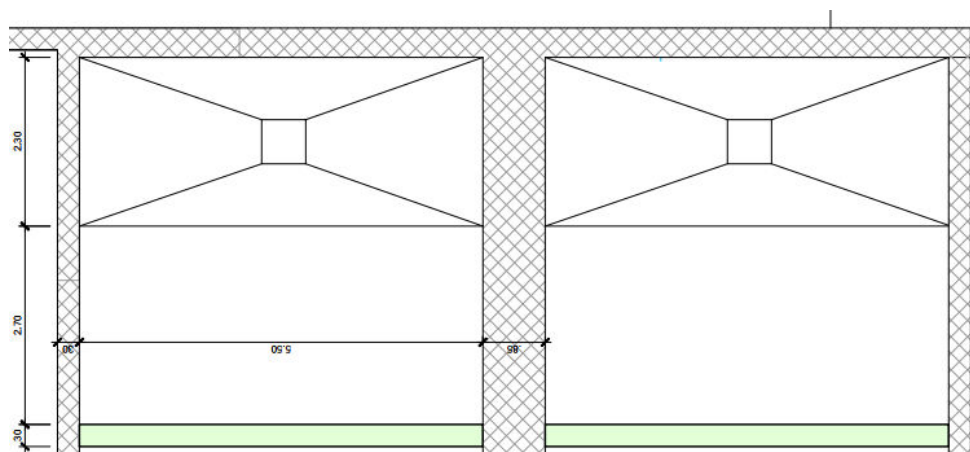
Nutzung Teil der VKB als Pumpensumpf (Grundriss)
